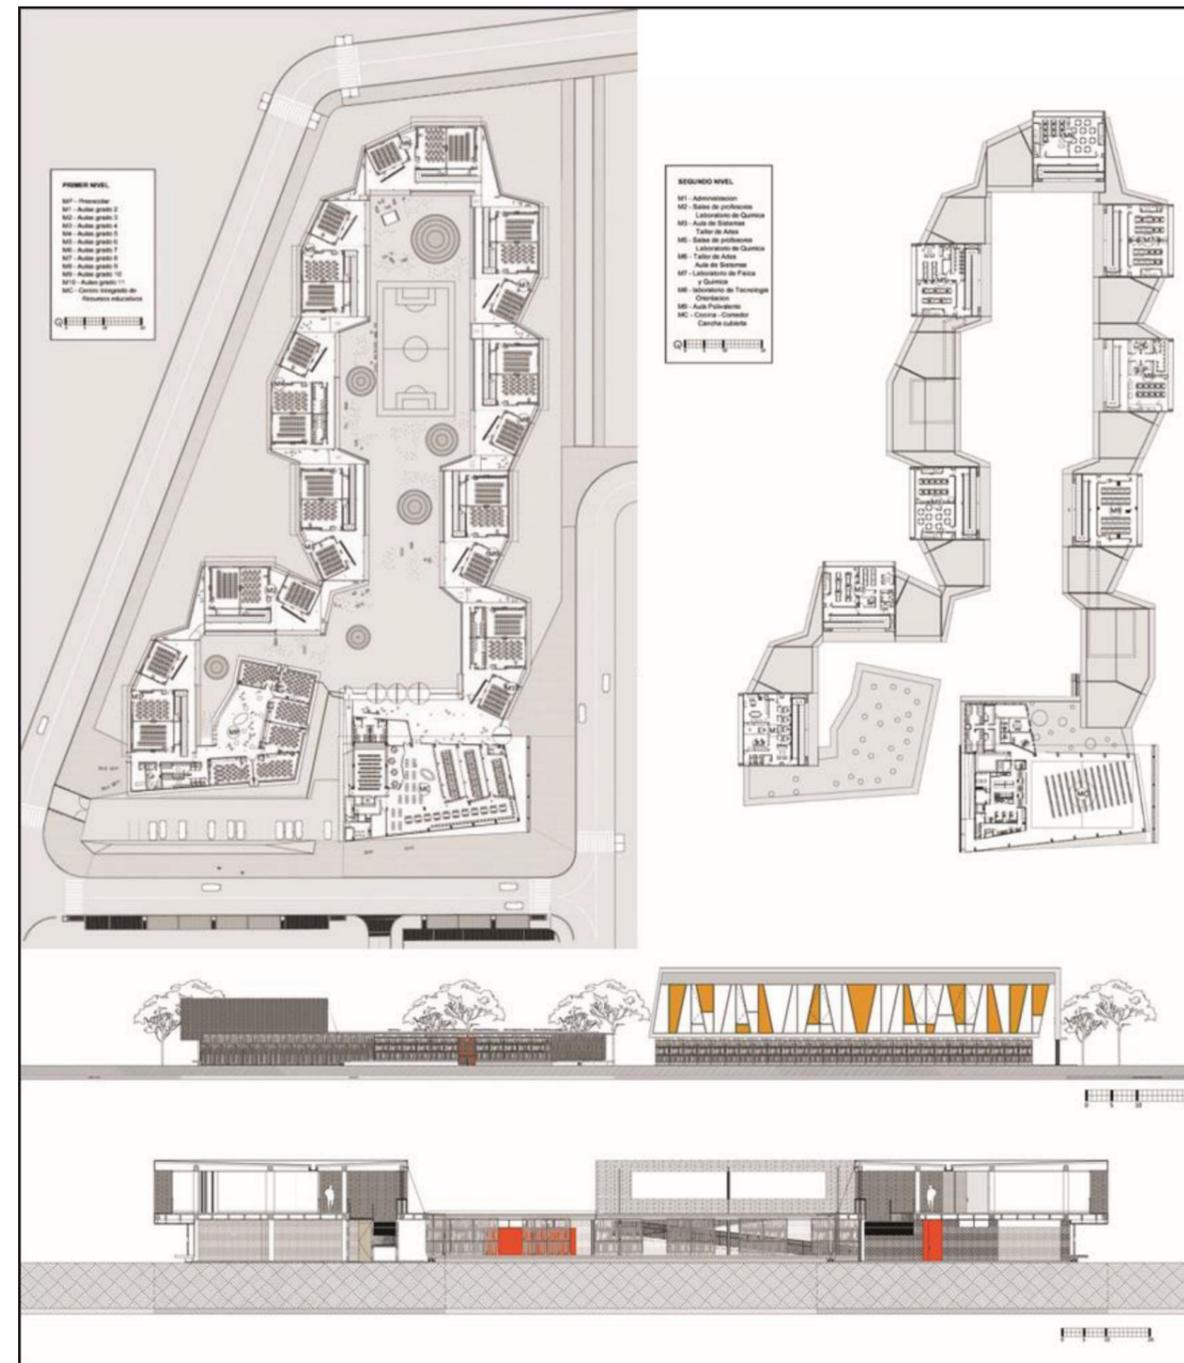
Plantas, Elevación y Corte Arquitectónico, Colegio Gerardo Molina
